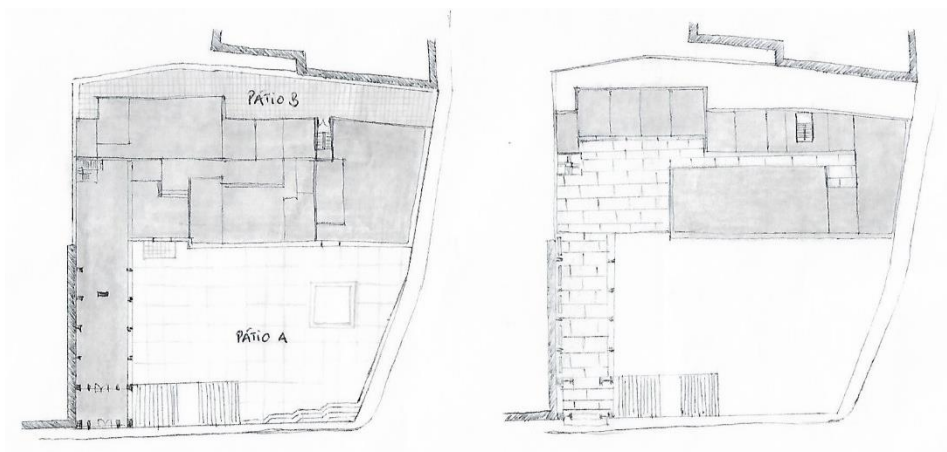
Planta piso 0 e piso 1, respetivamente. (escala 1/500)
